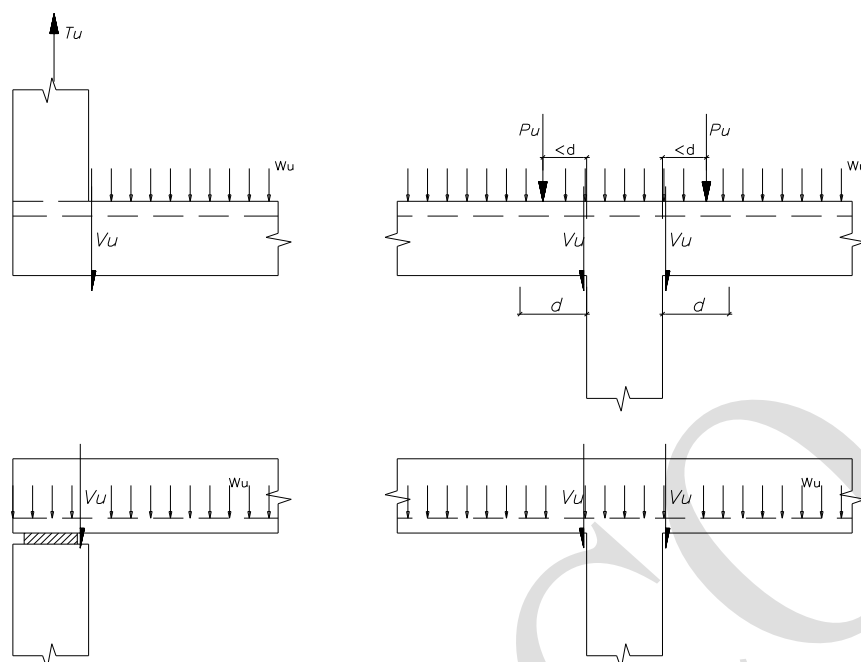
b Condiciones de apoyo y de aplicación de las cargas externas en las cuales no se puede reducir la fuerza V_u de diseño.
